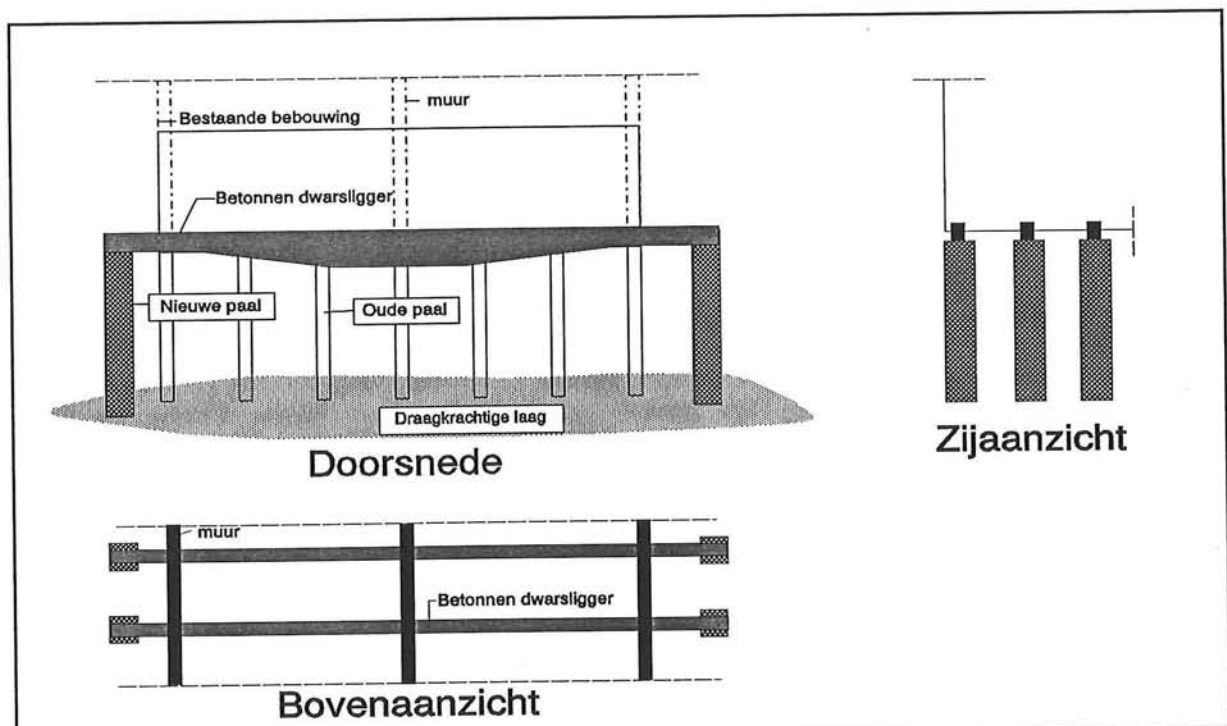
Aanbrengen funderingsconstructie onder bestaande bebouwing
